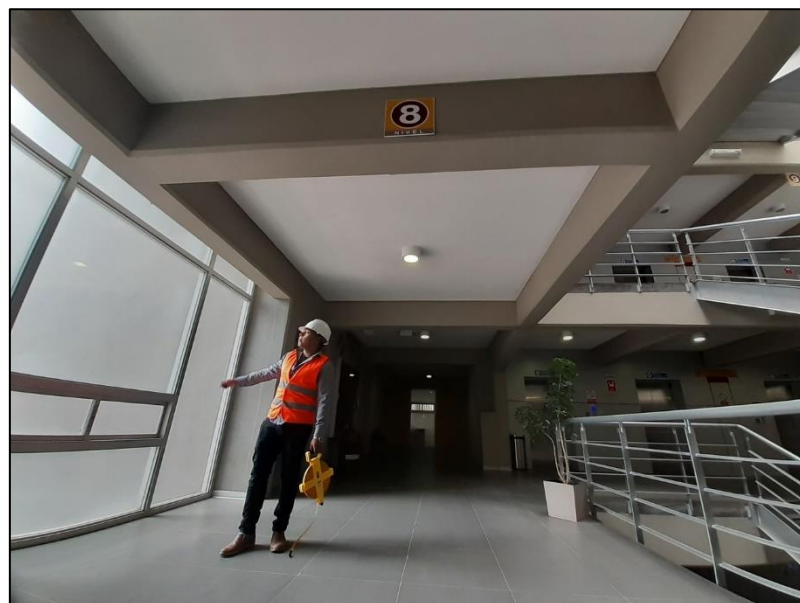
Medición de Vigas y Losas*Figura 158*Reconocimiento de Vigas en Voladizo
